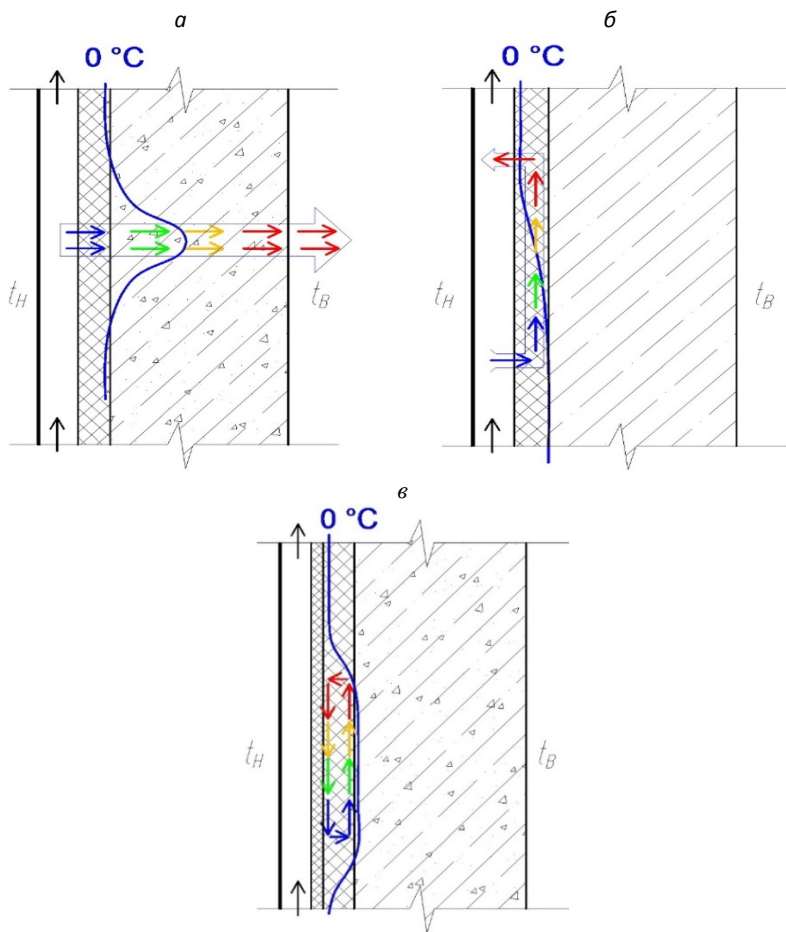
Смещение нулевой изотермы при фильтрации воздуха в наружных стенах (на примере вентилируемой фасадной системы утепления):
